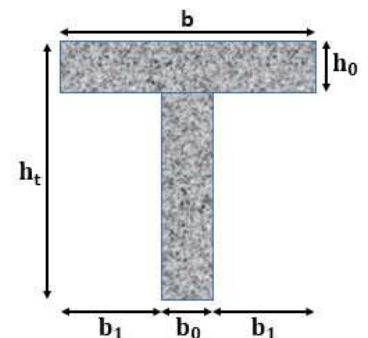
Coupe transversale des poutrelles en T
